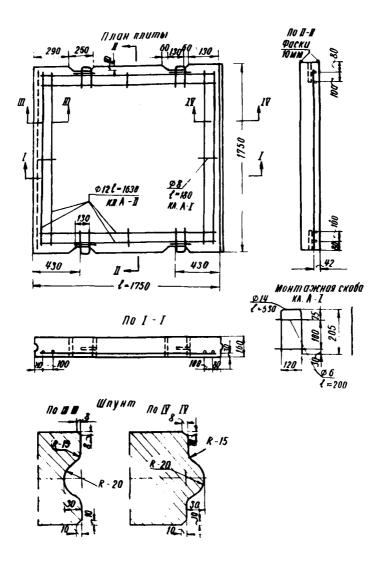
Дорожная плита 1,75х1,75м с армированием по контуру. Расход арматуры 4,8 кг/м 2
